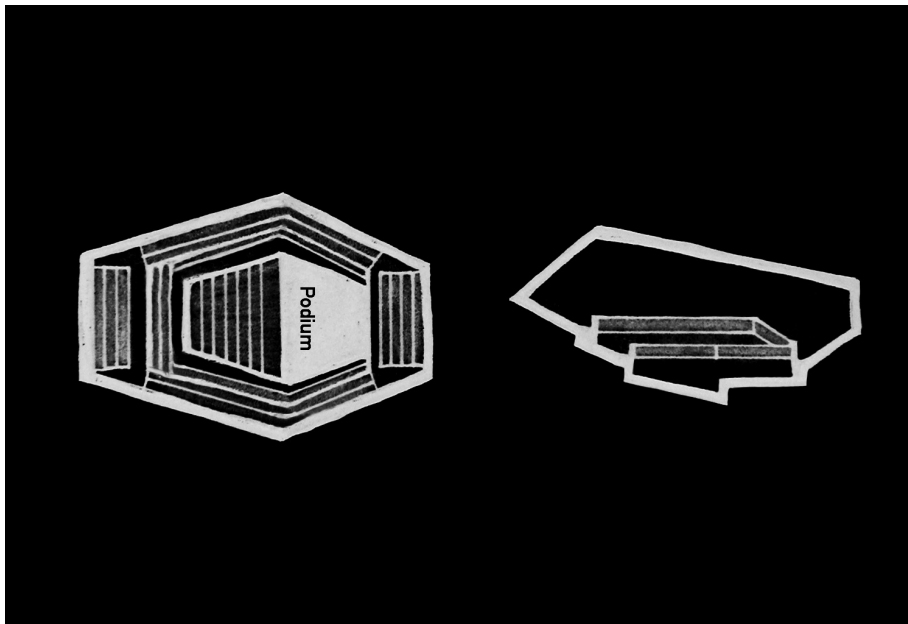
Arena-Saalform (Grundriss, Längsschnitt). Skizzen: Sian Brehler, 2006.
